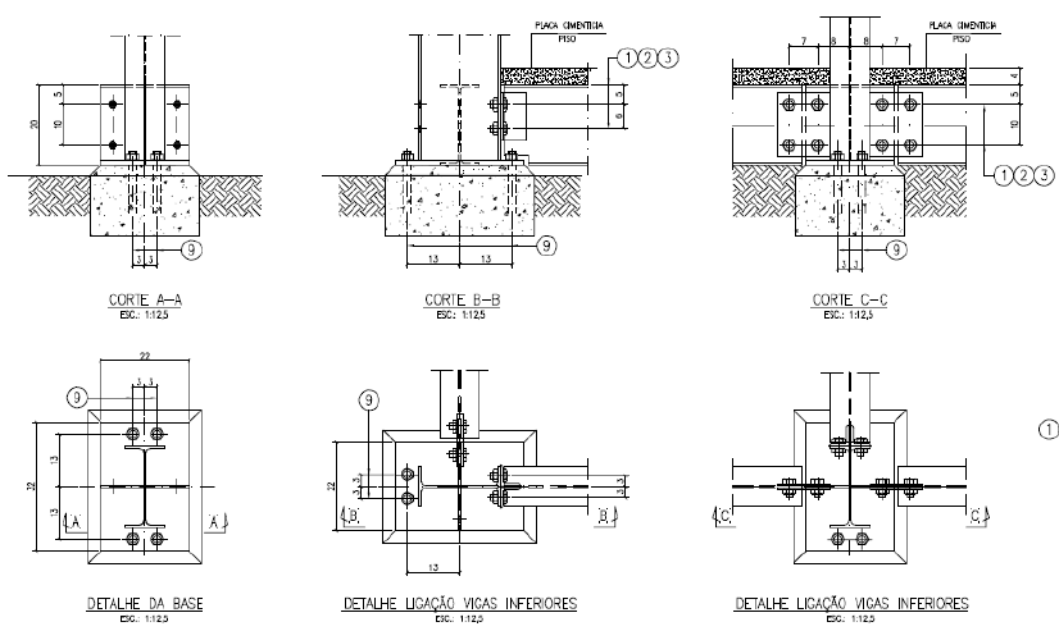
Detalhes do Projeto Executivo Vigas Inferiores-
